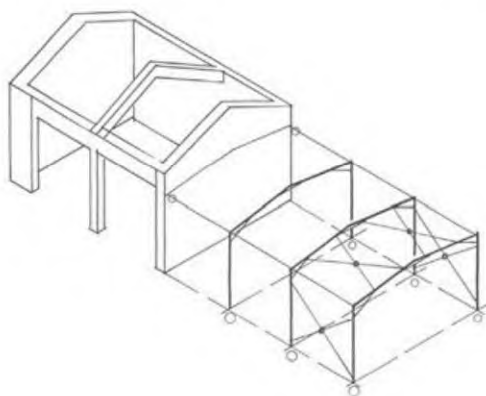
Addition d'un bâtiment souple à un bâtiment rigide.
